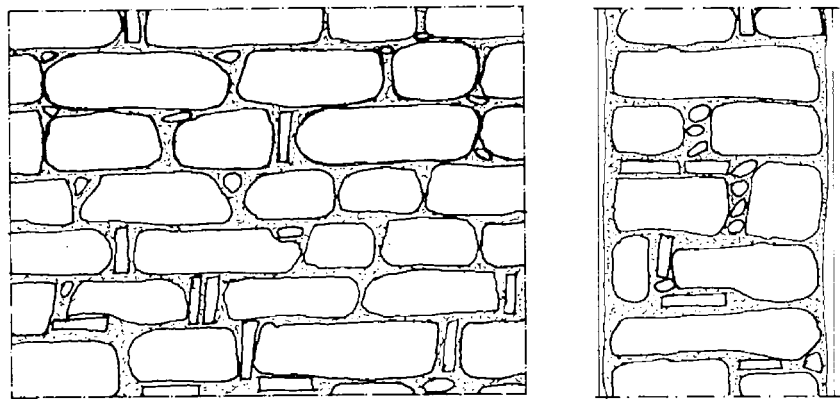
Muratura a tessitura regolare (Randazzo 1988).
